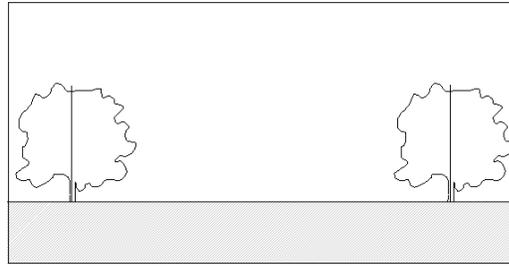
Alzado definido utilizando el rango de vista de la imagen a la izquierda de la ilustración anterior
